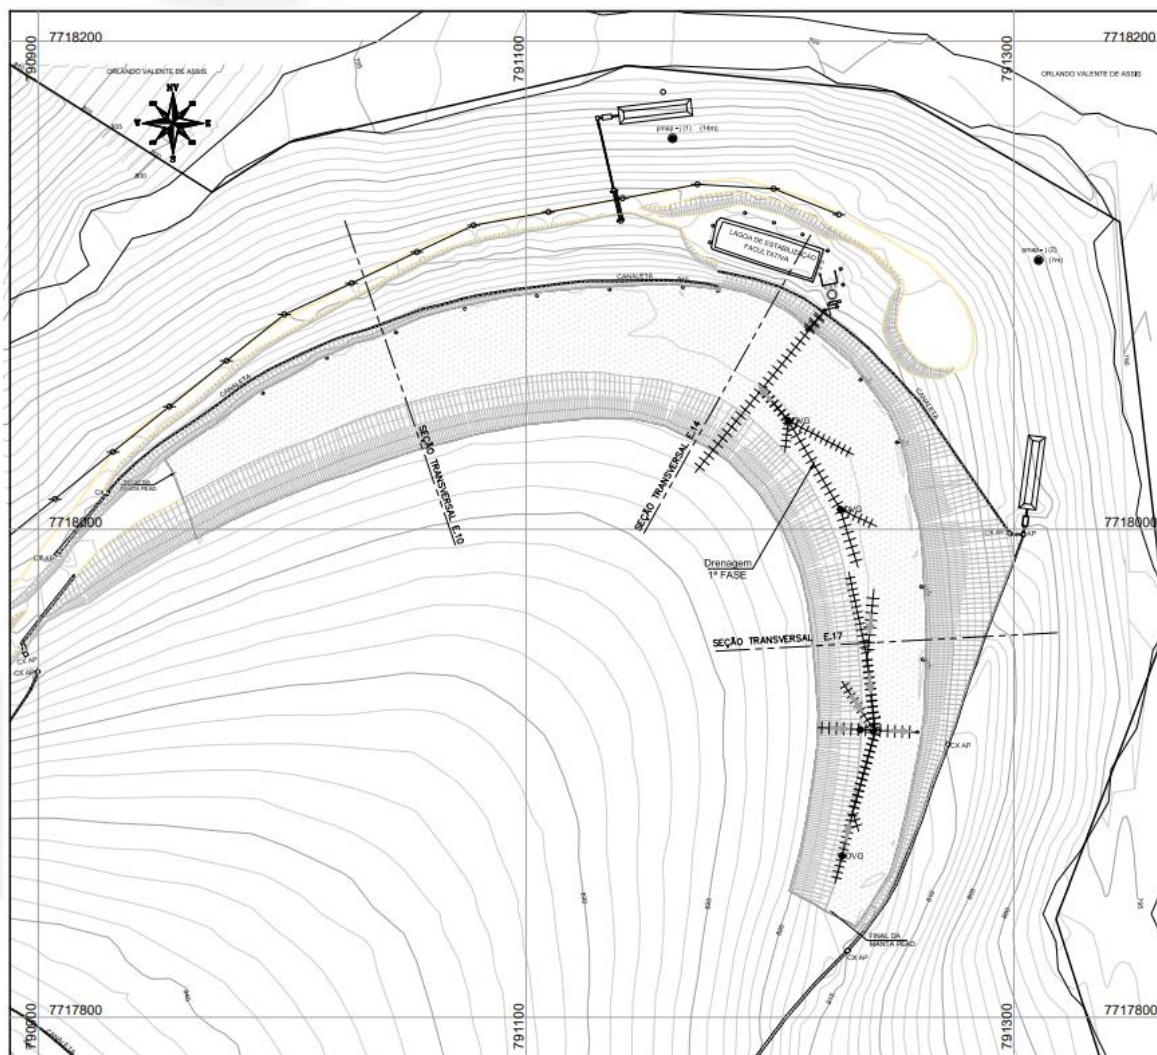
Planta da plataforma 1: drenagem de fundo 1ª fase.
